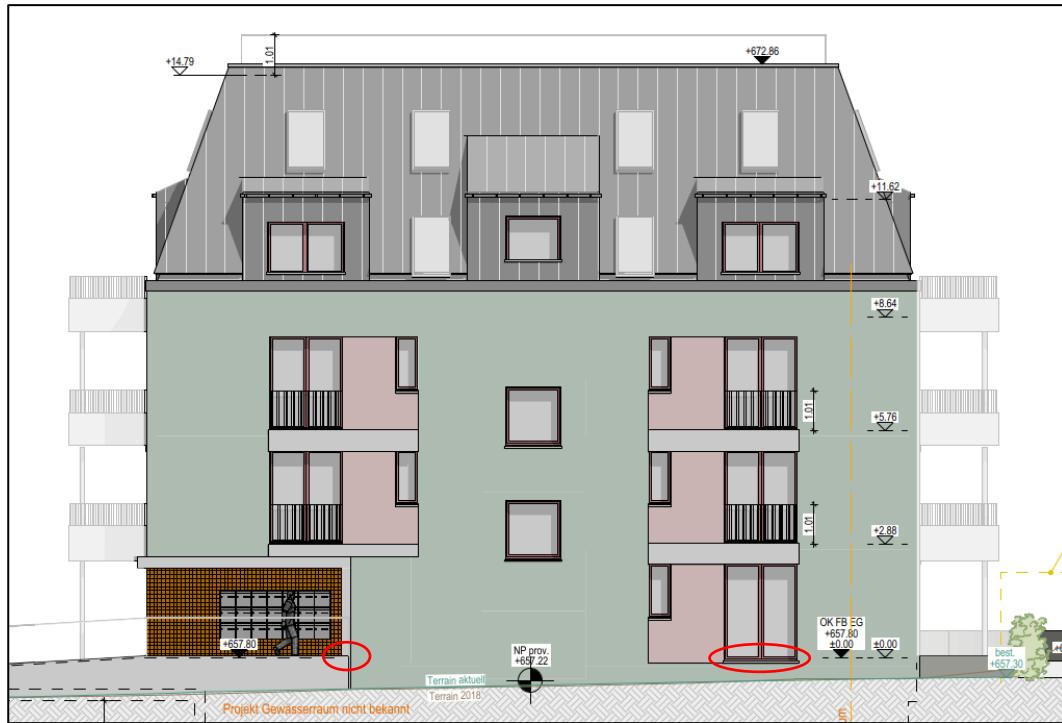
Fassadenansicht Nordseite Haus B, mit Markierung gefährdete Öffnungen
